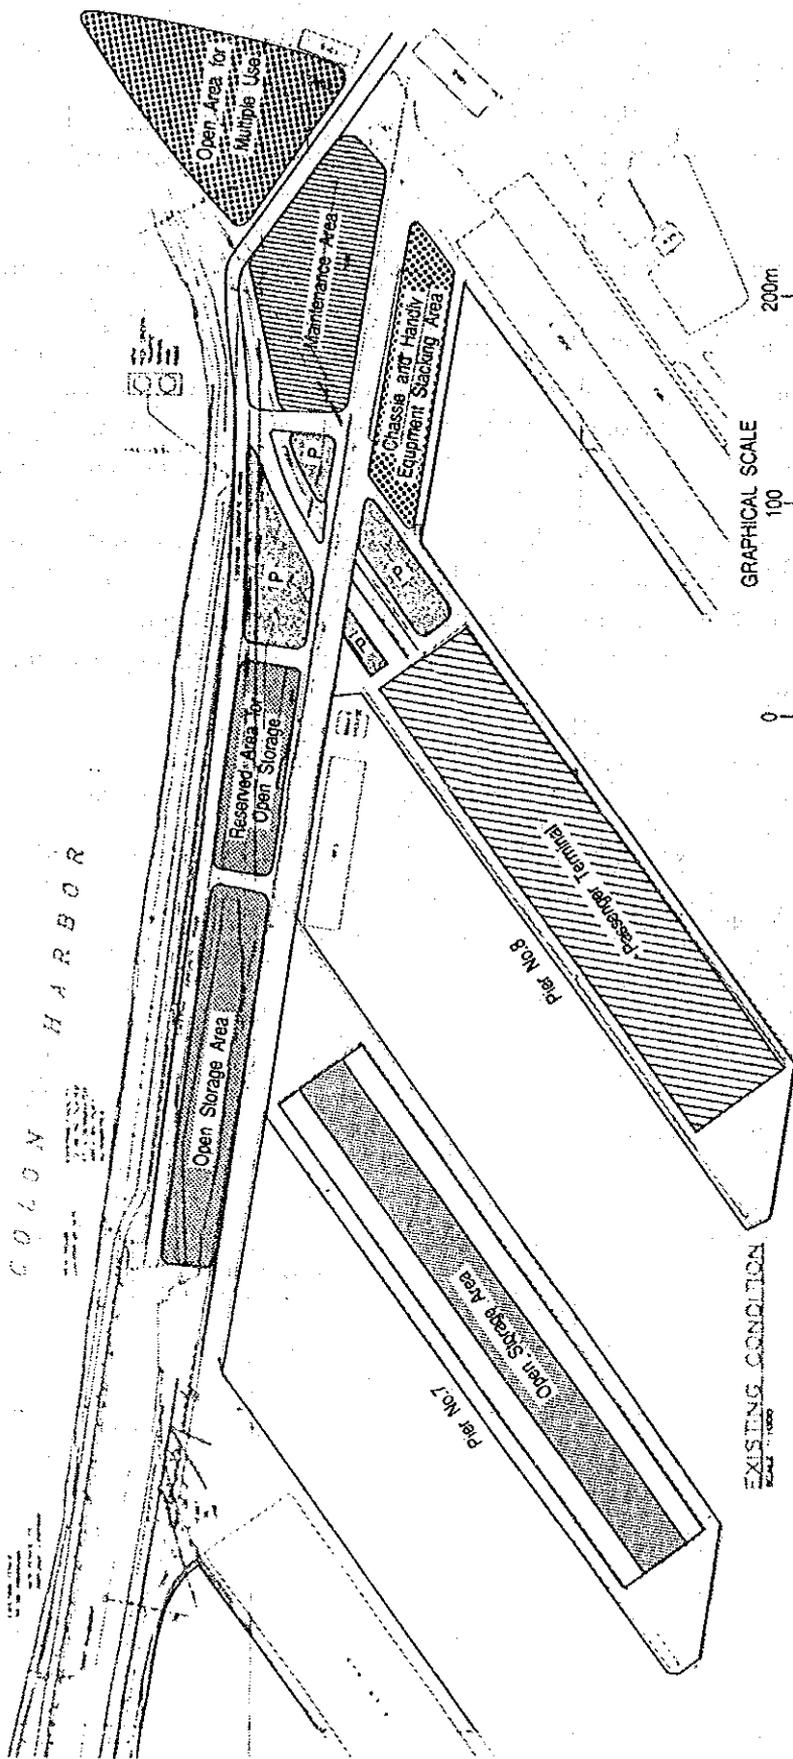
Area de Uso de Terreno del Espigón (Plan Maestro)
